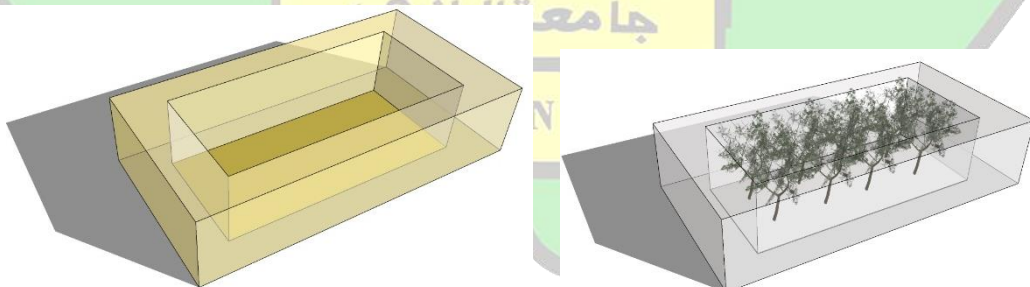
Konsep Bangunan/Gubahan Massa
